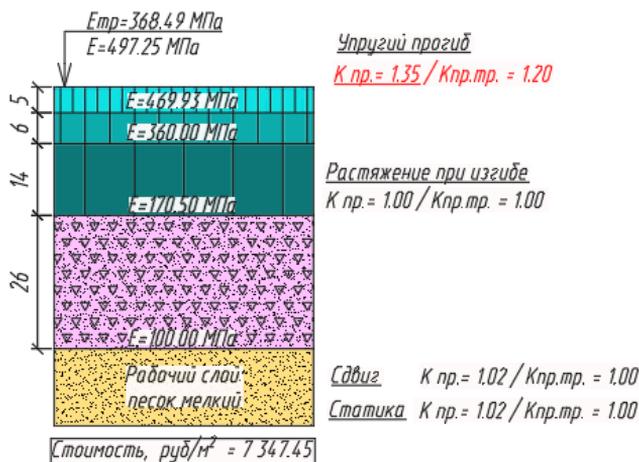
Результаты расчета конструкции дорожной одежды без армирования асфальтобетонного покрытия
